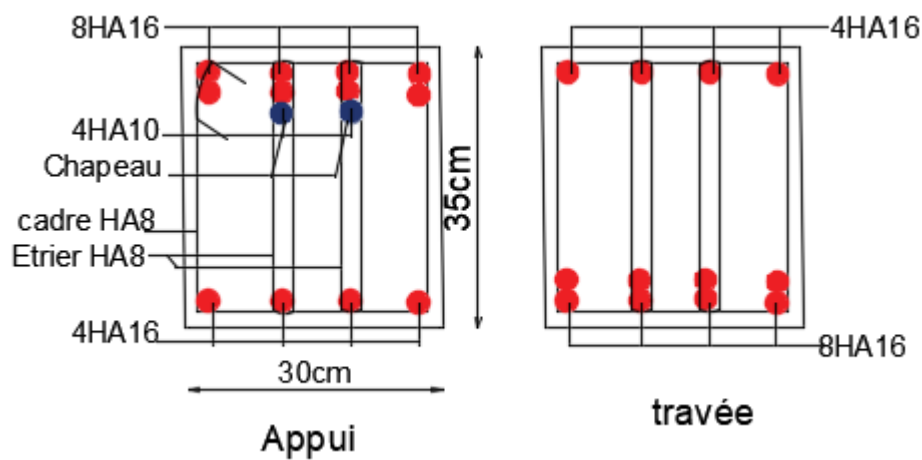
Schéma de ferrailage de la poutre secondaire du plancher étage 7
